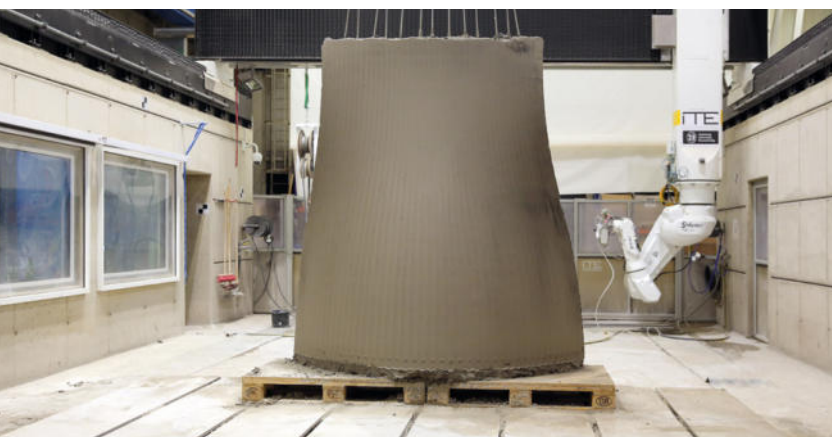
Im SC3DP-Verfahren gefertigte freigeformte und geglättete Betonwand mit integrierter Stahlbewehrung
